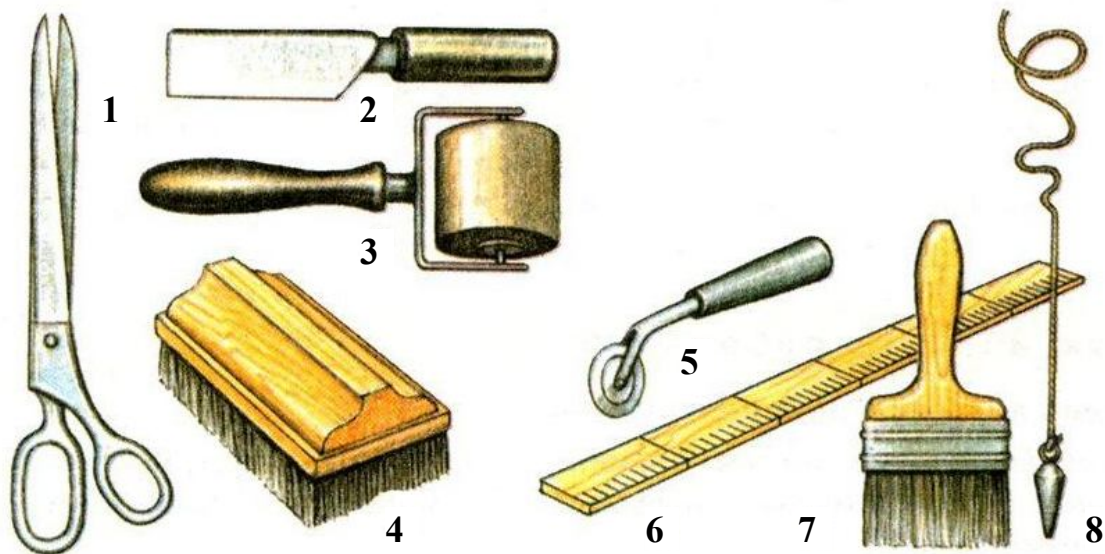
Пристосування та інструмент для наклеювання шпалер:
